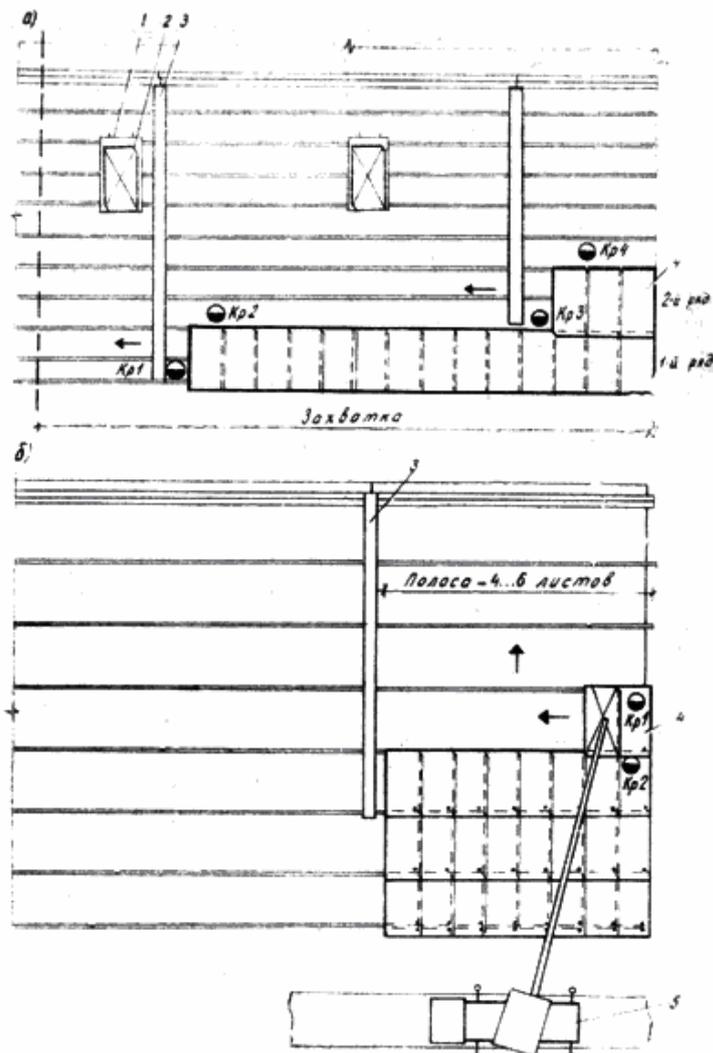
Организация работ при устройстве кровельного покрытия из асбестоцементных волнистых листов: а – порядная; б – полосами от свеса к коньку; 1 – инвентарная площадка; 2 – стопка листов; 3 – трап; 4 – листы в покрытии; 5 – кран
